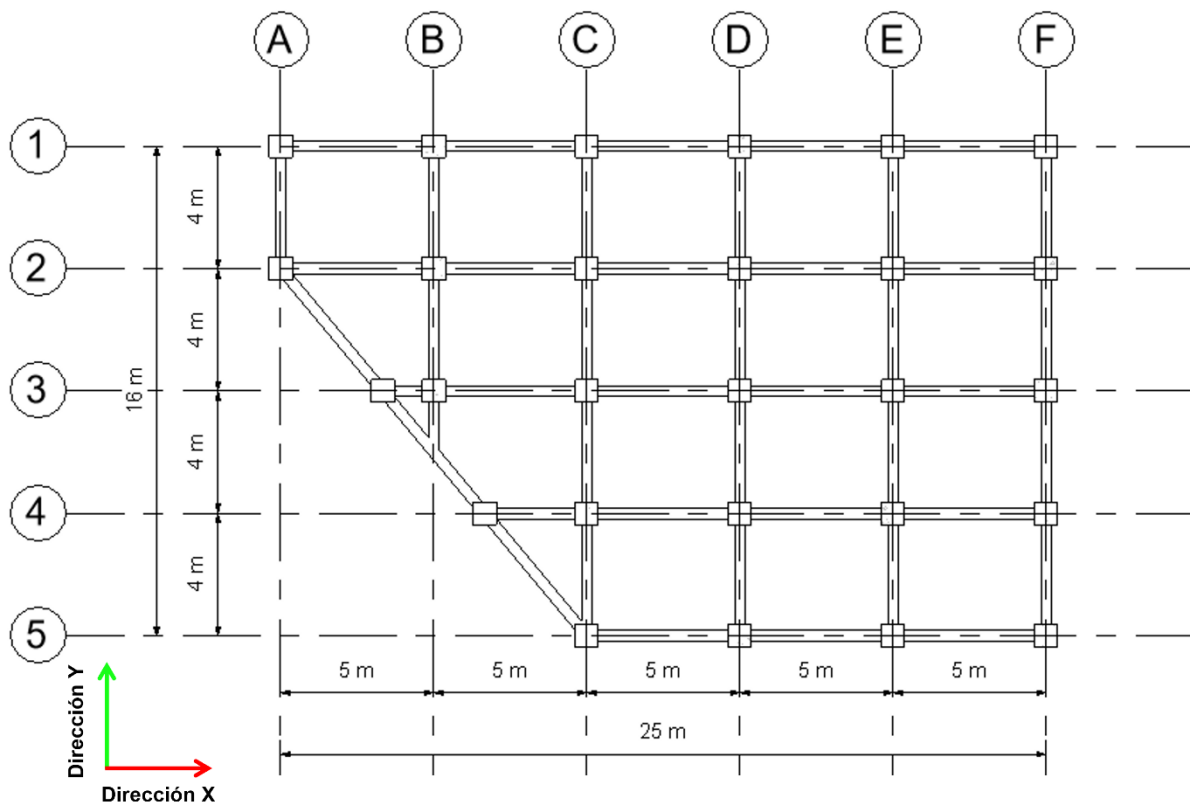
Planta tipo para el edificio estructurado con marcos. Fuente: elaboración propia.
